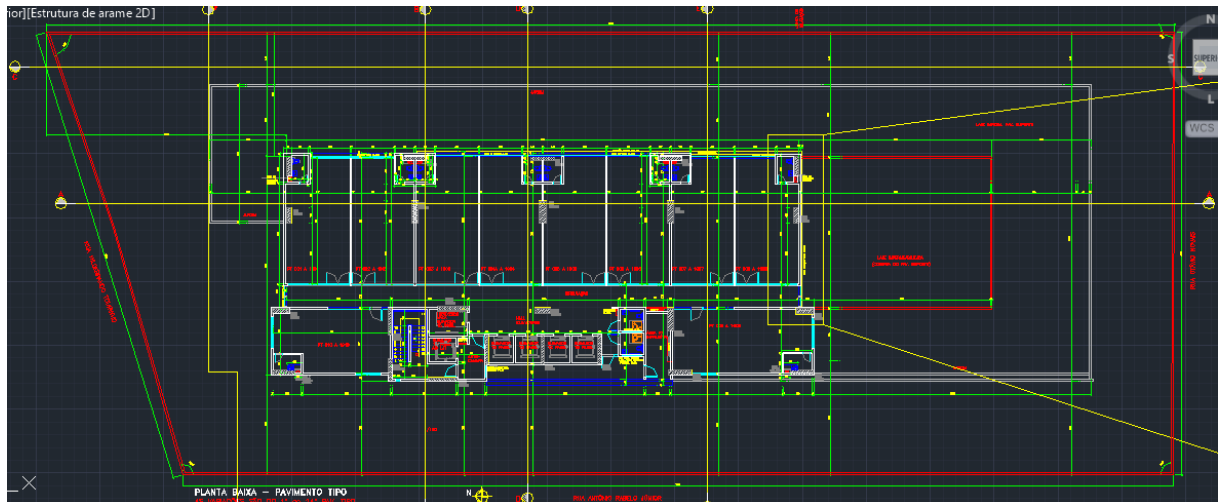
Planta Baixa Pavimento Térreo do ECO Medical Center
